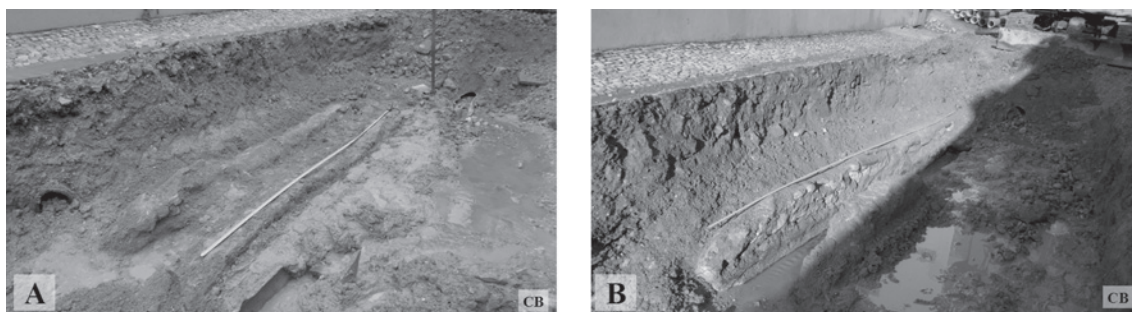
A/B – Aspetos da escavação da conduta de saneamento em tijolo identificada na Travessa das Capuchas. Fotos: C. Boavida.
